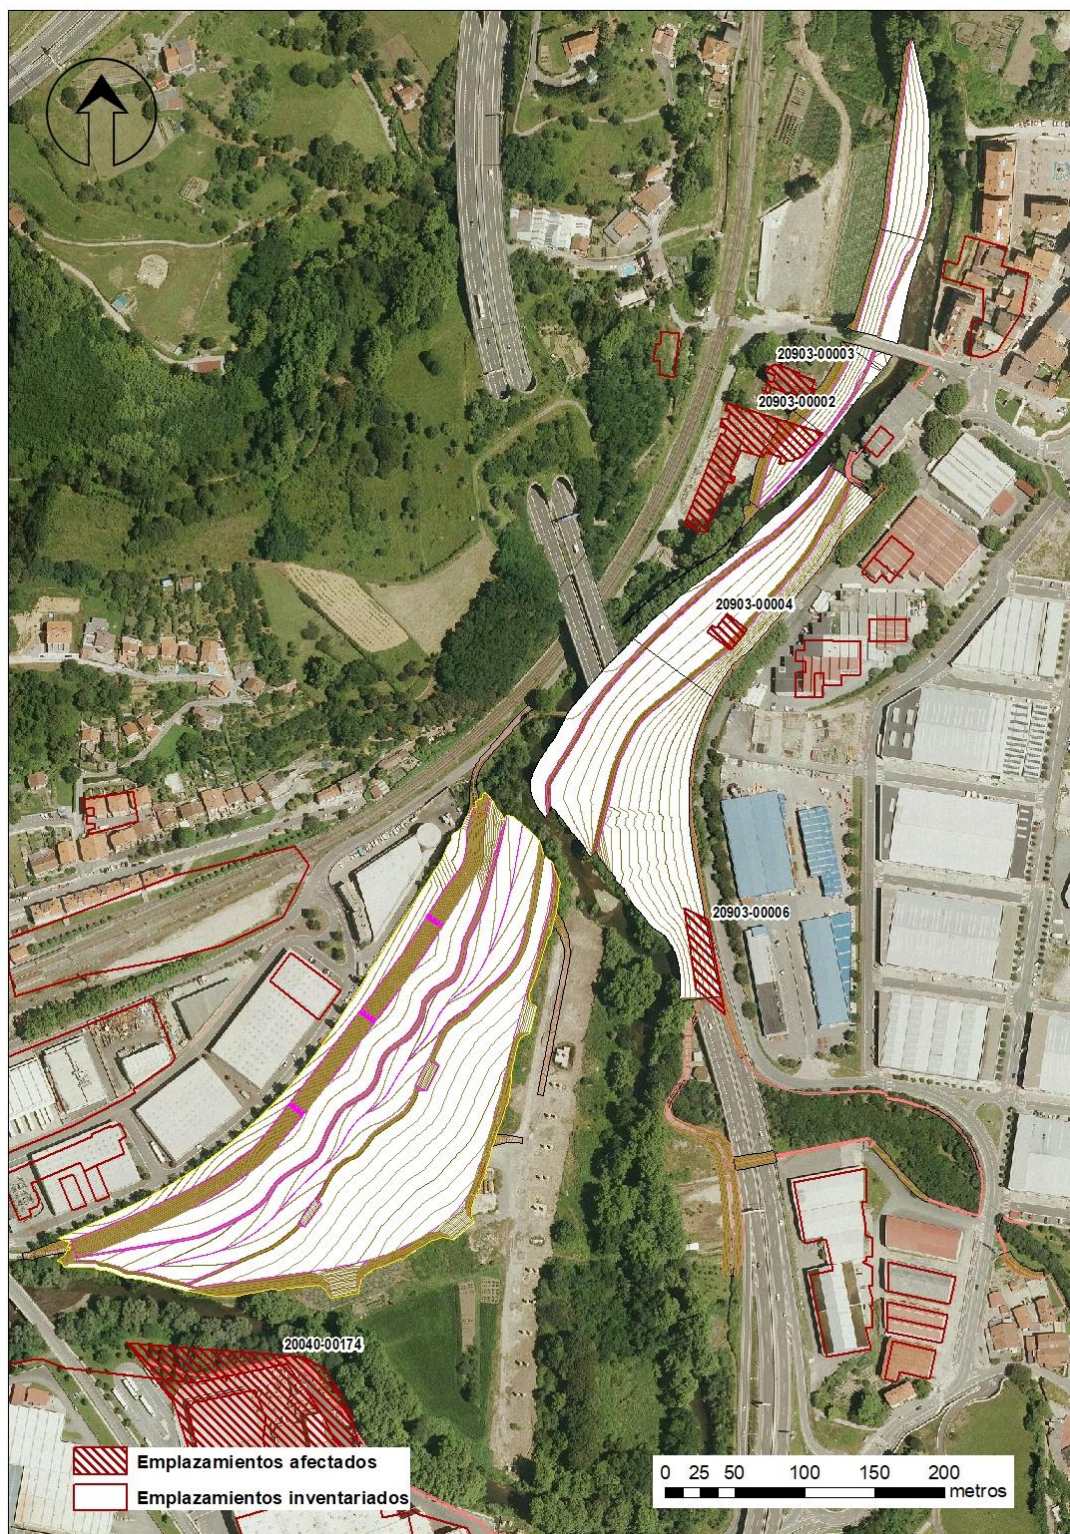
Planta futura del encauzamiento con la situación de las parcelas de suelos potencialmente contaminados.
